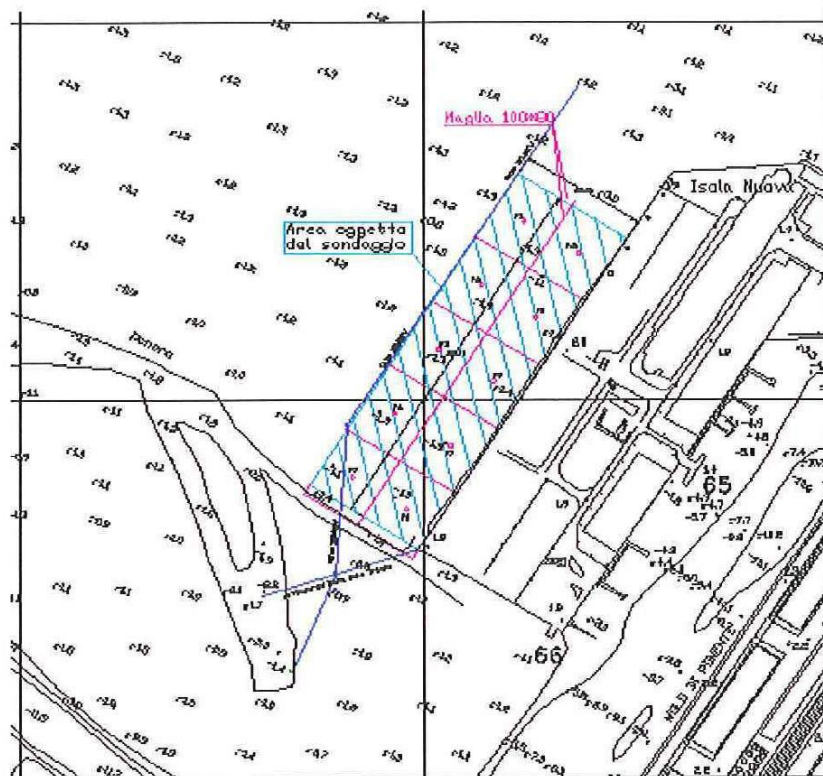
Planimetria con individuazione dei punti di campionamento
